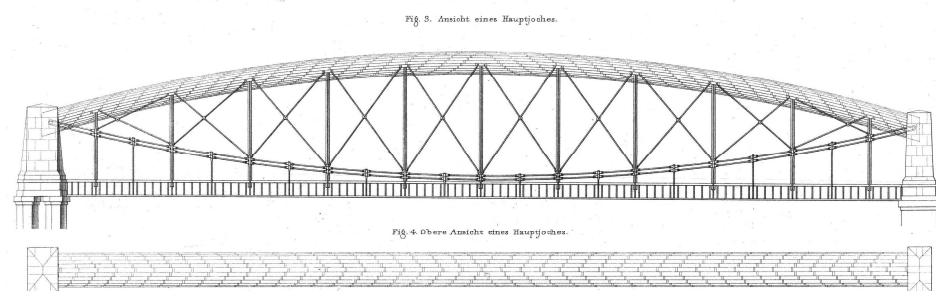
Längsansicht der Hauptöffnung der Royal Albert Bridge von Isambard Kingdom Brunel, 1859
